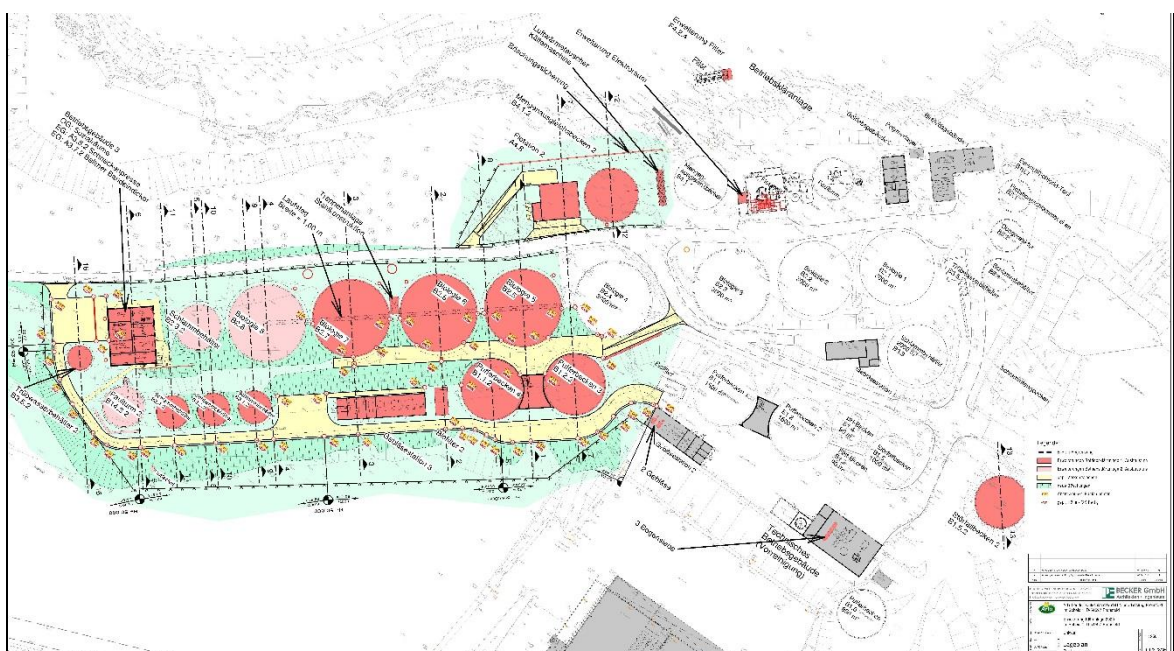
Lageplan zur geplanten Betriebskläranlagenerweiterung – Stand 30.04.2019.
